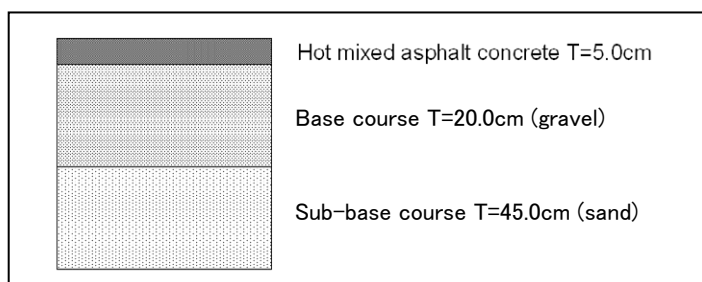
Altura de las Capas de Pavimento de Concreto
